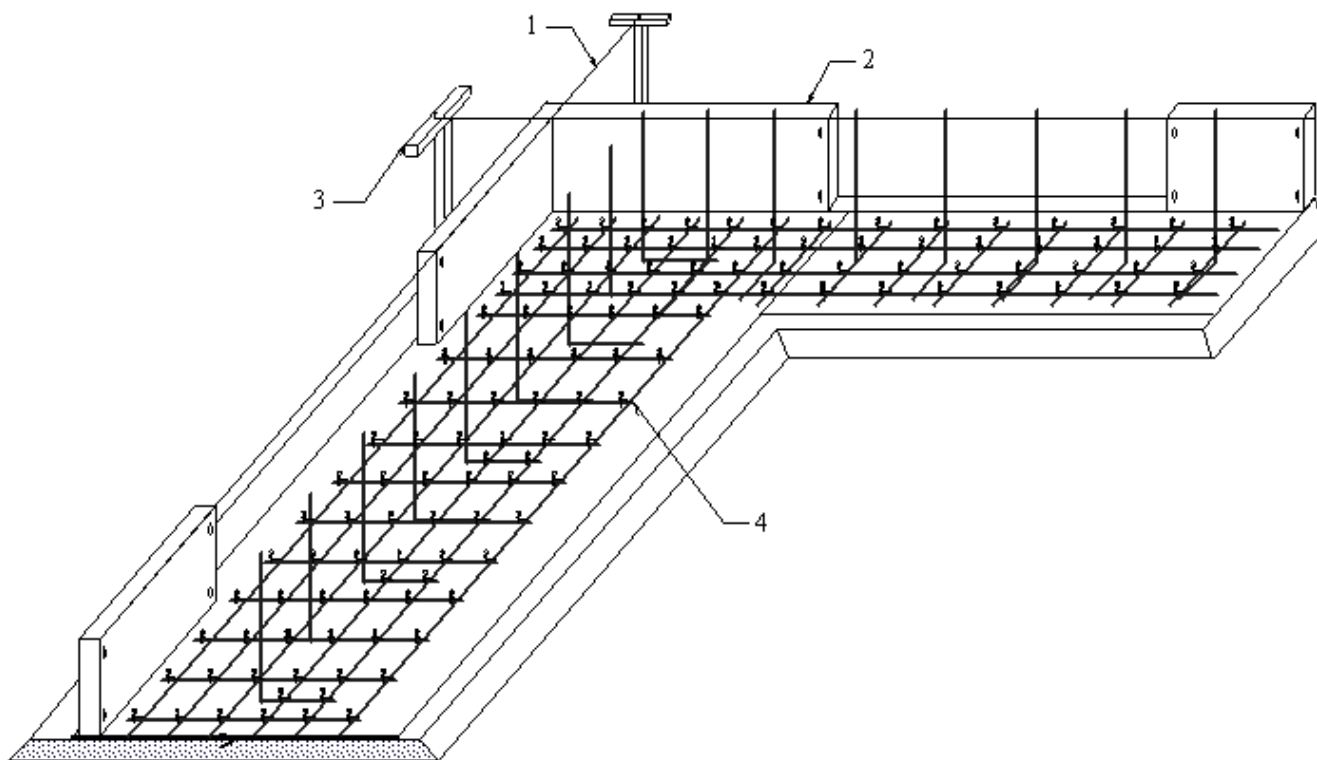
Монтаж опалубочных щитов: 1 – разбивочный шнур; 2 – угловой щит; 3 – обноски; 4 – арматурный каркас
